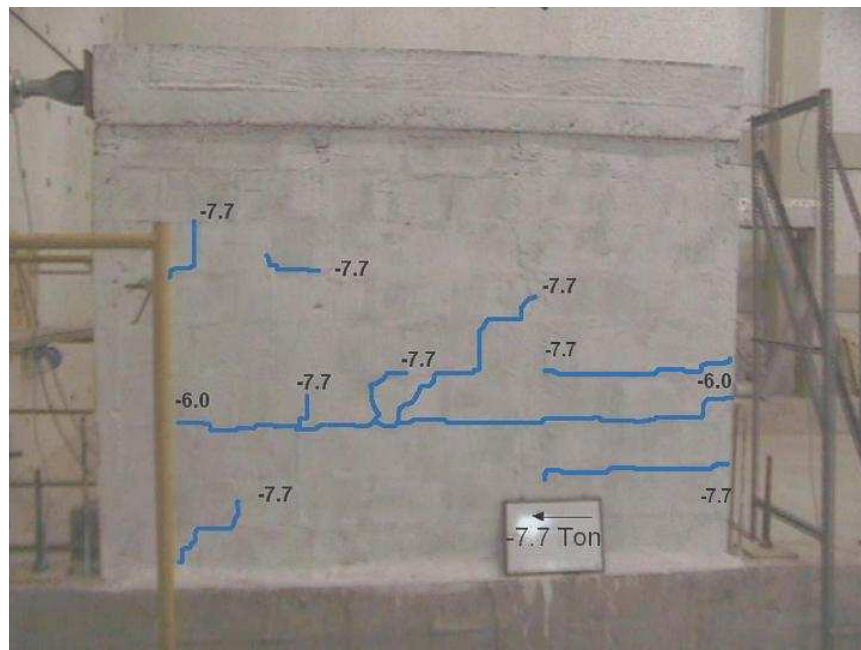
Fisuras en la pared a las 7,7 t de carga negativa
